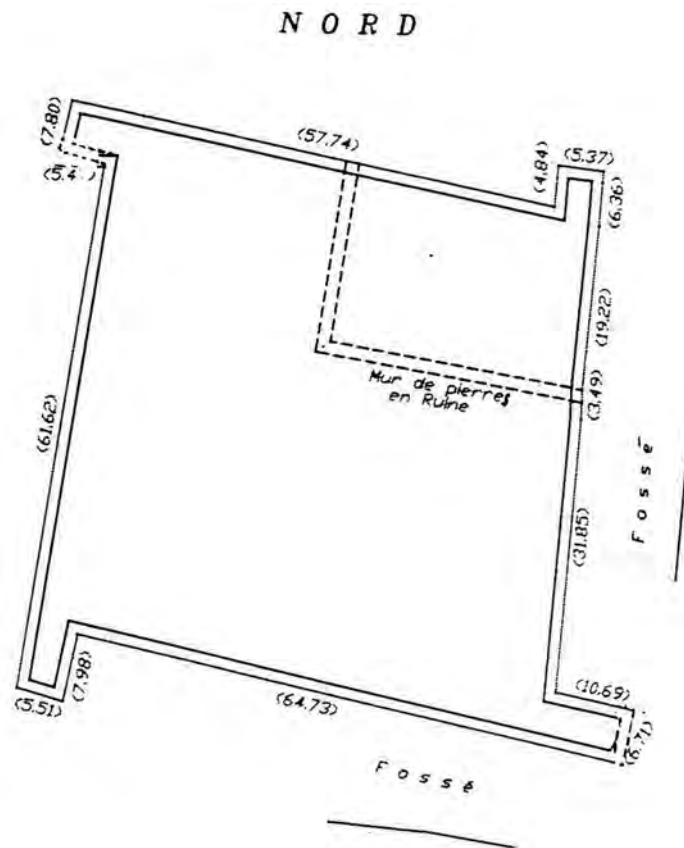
Levantamento da planta de Anga. / Plan relevé du site d'Anga.
